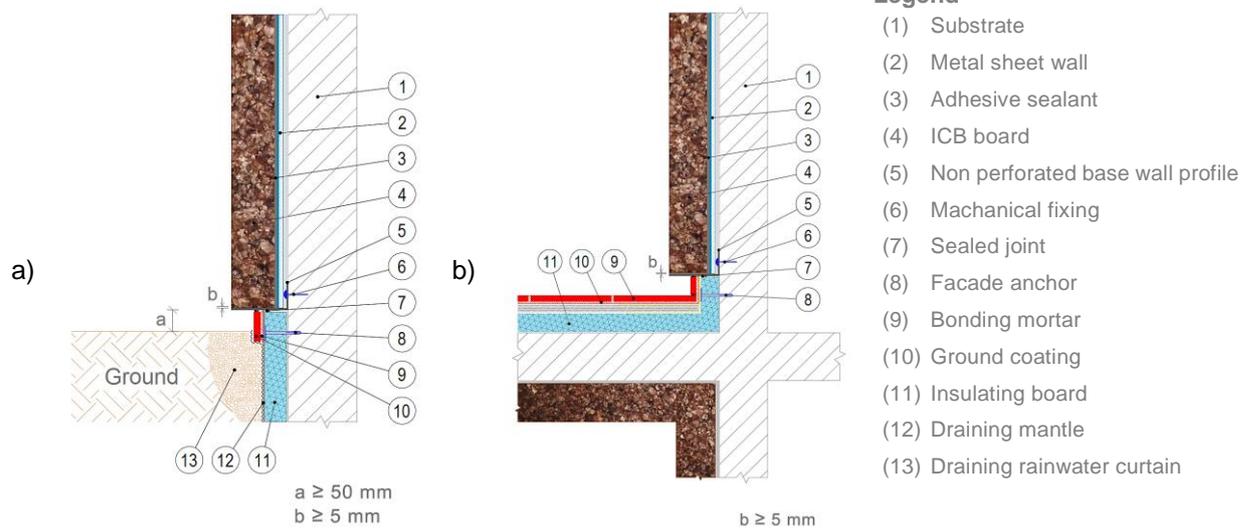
Détails du mur de soutien : a) Système partant du sol ; b) Système partant d'un balcon ou d'une terrasse.
